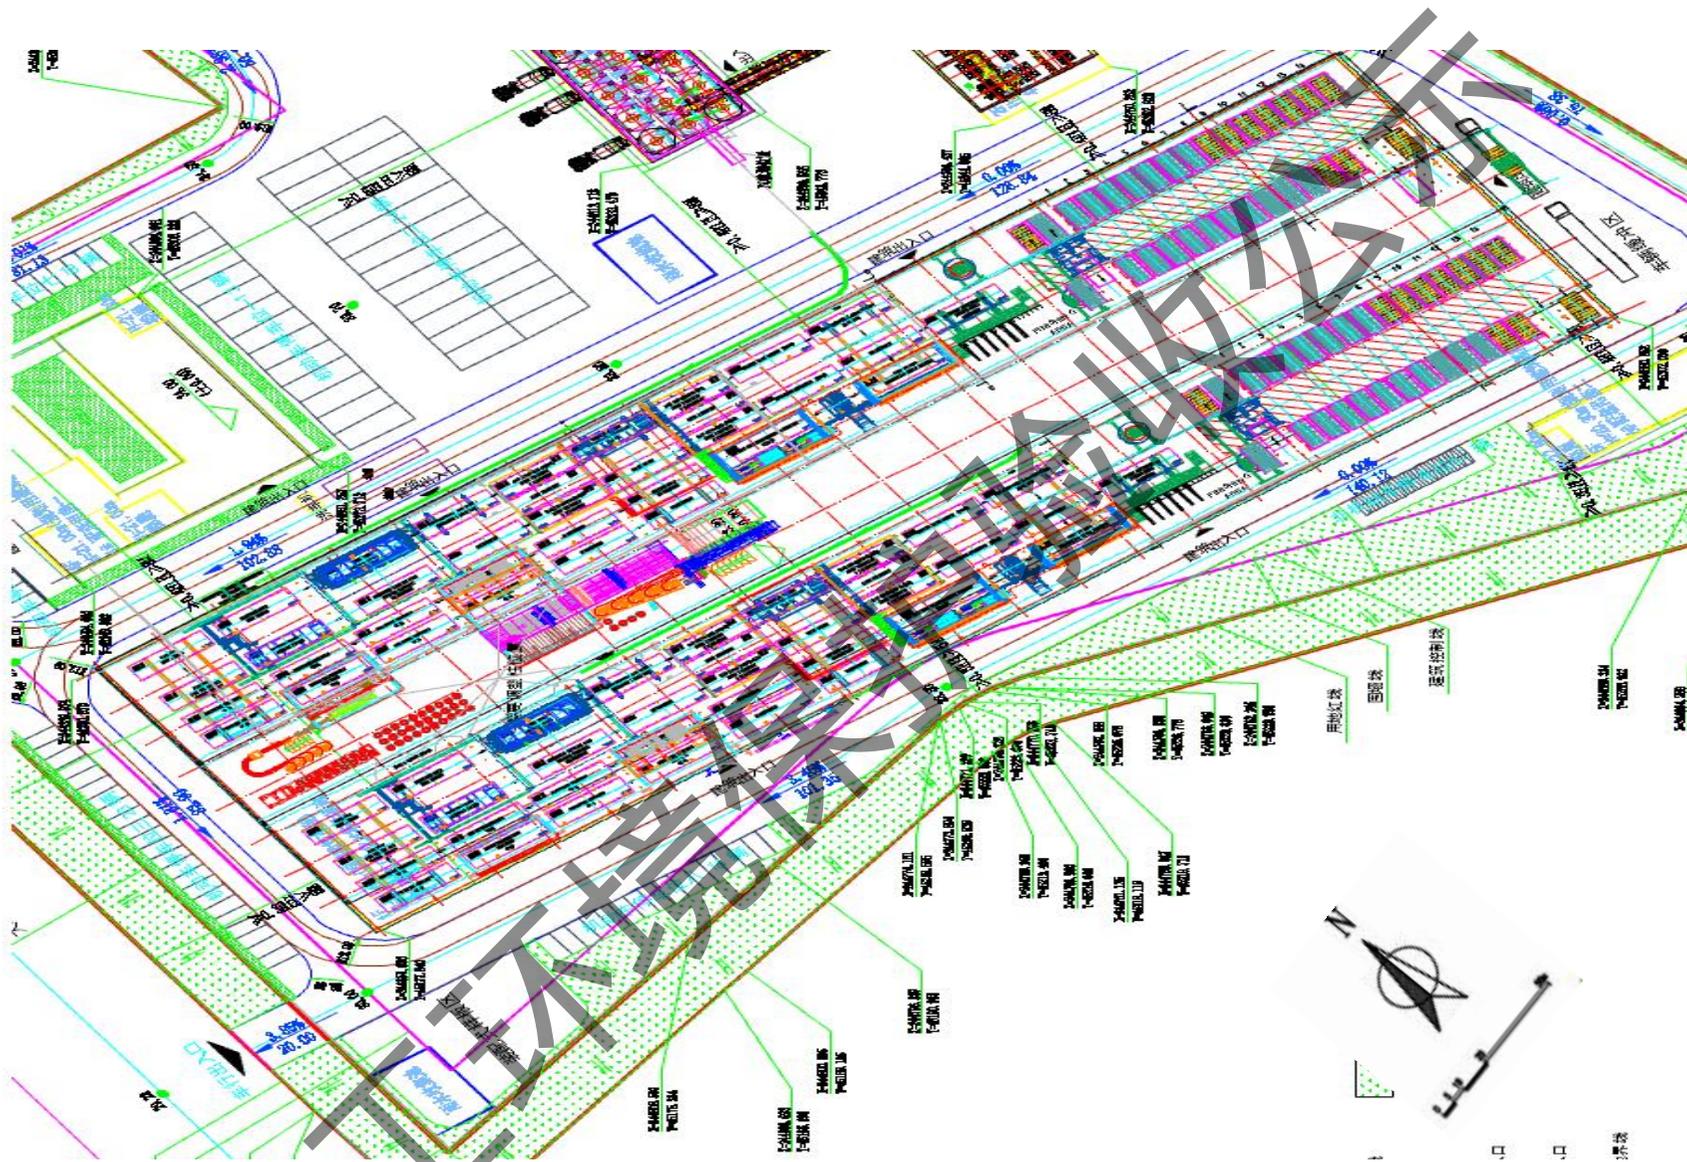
(2) 平面布置图 (A1 厂房平面布置图)
